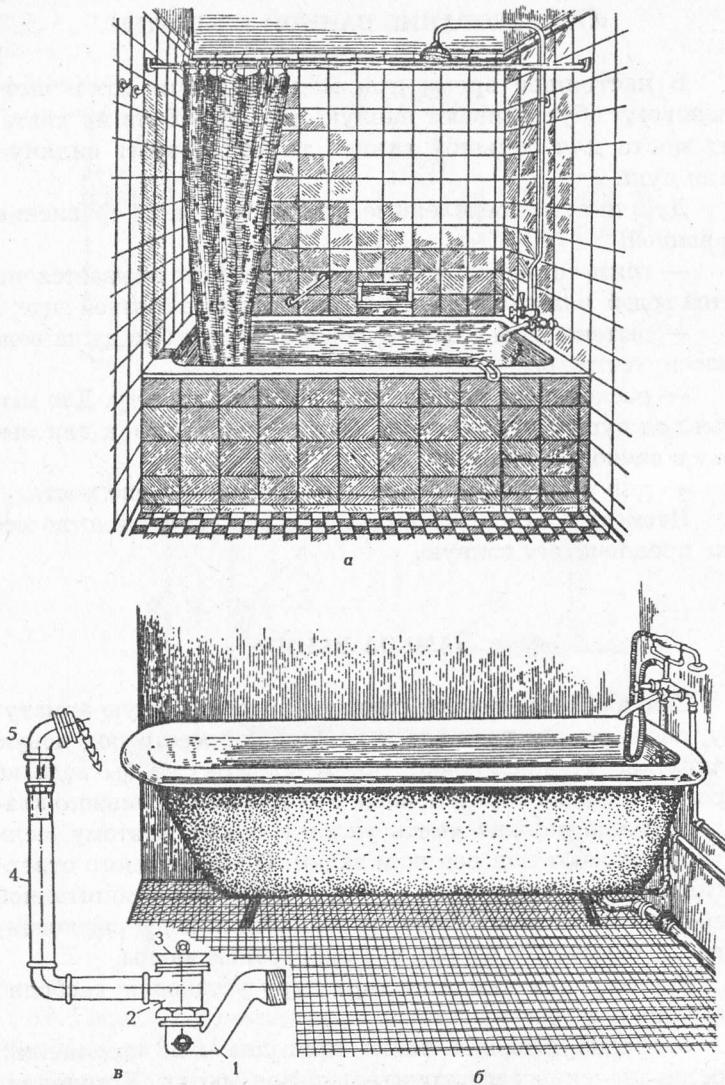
Прямобортная (а) и круглобортная (б) ванны и деталь переливной трубы (в): 1 — напольный сифон, 2 — тройник, 3 — выпуск из ванны, 4 — переливная труба, 5 — перелив
